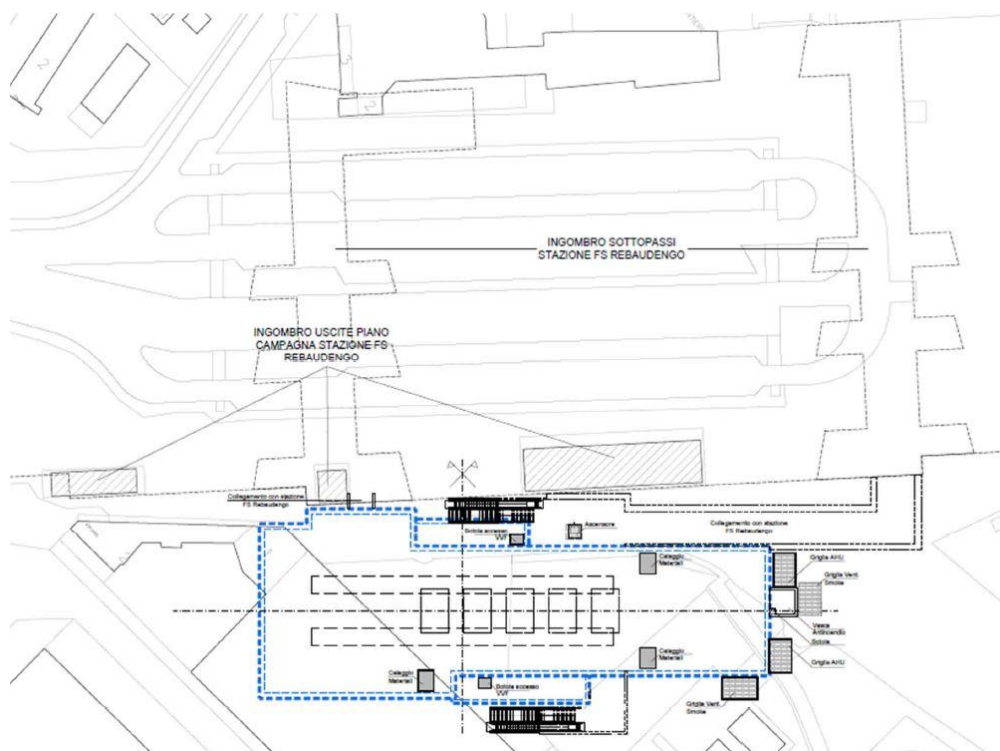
Layout generale della stazione FS esistente e della connessione con la stazione metro
